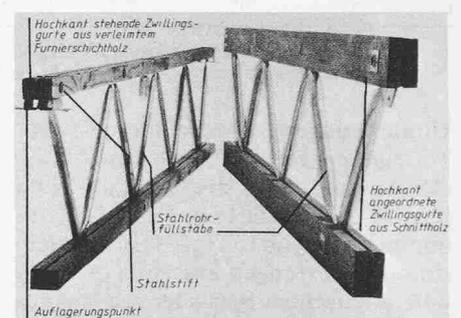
Truss Joist mit Gurtungen aus Furnierschichtholz
